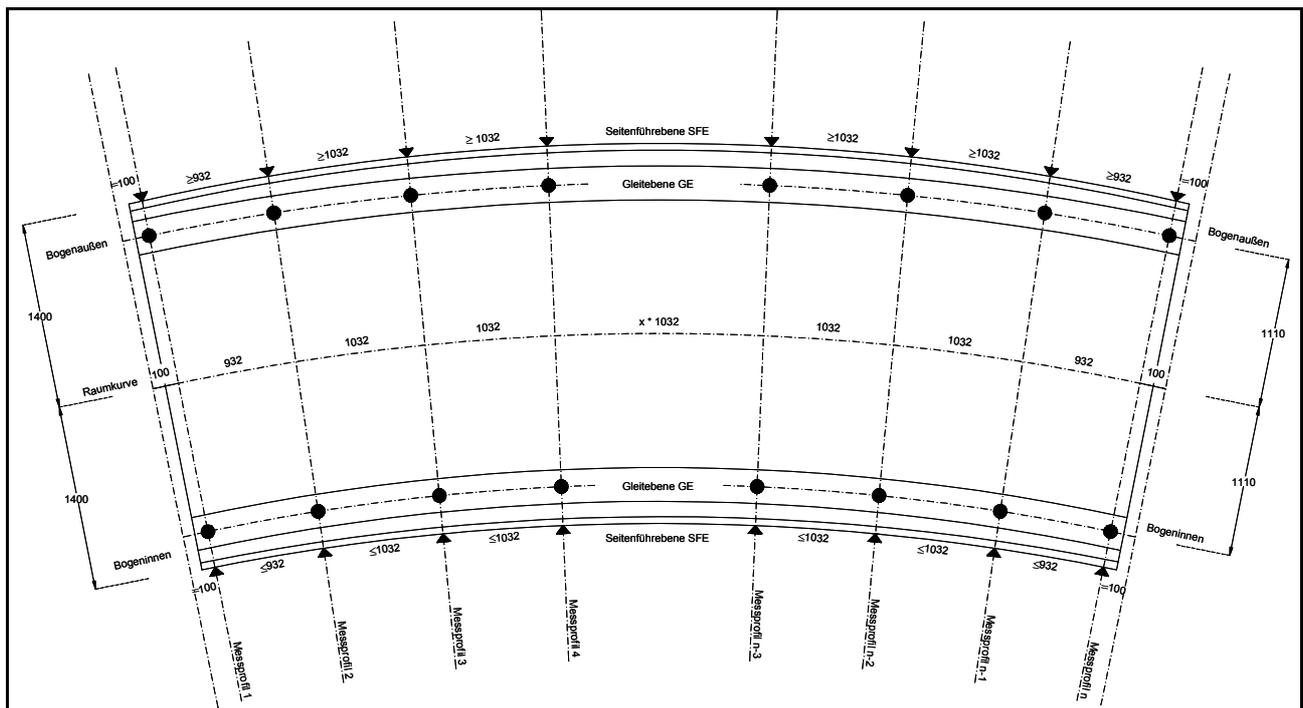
Points de mesure principaux du plan de guidage latéral et du plan de glissement
